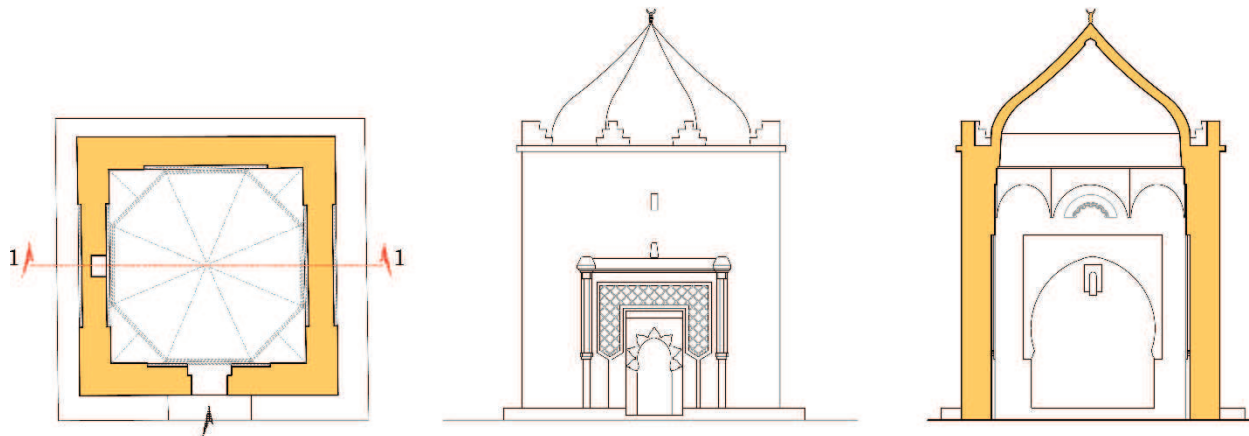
Vue en plan, façade et coupe du tombeau de Bellaameche, (échelle : 1/200).
